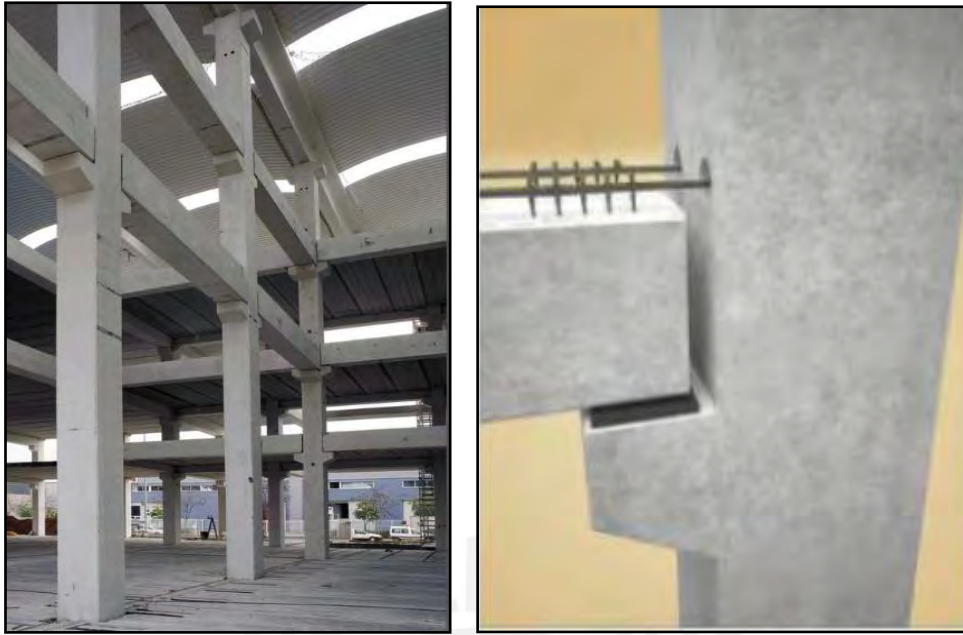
Montaje de vigas sobre las columnas con ménsulas conexión no emulativa semirrígida (Tecnyconta, n.d)
